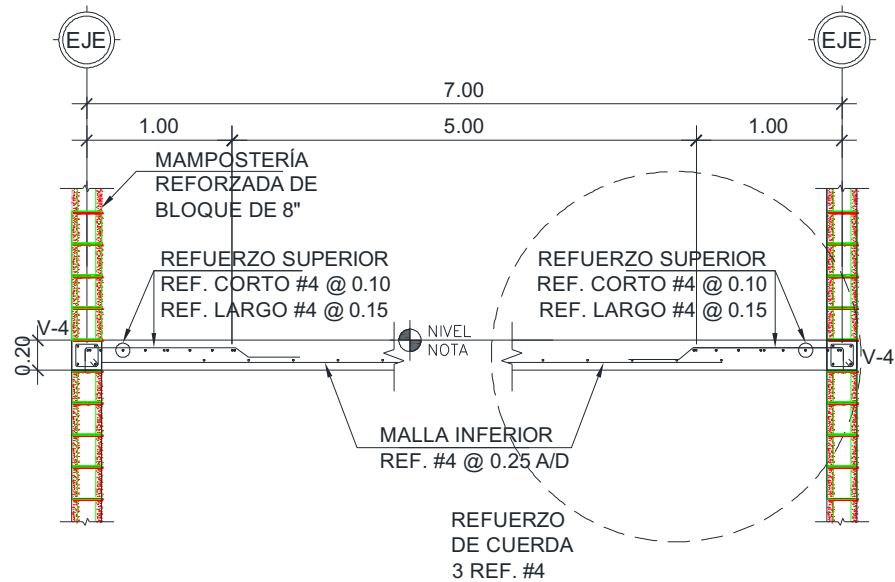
Sección transversal de Losa de Entrepiso en Dirección Transversal
